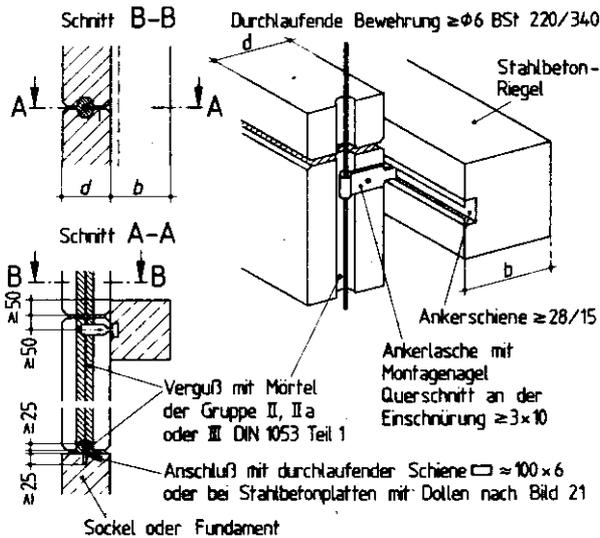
Anschluß von nichttragenden, stehend angeordneten Wandplatten an Stahlbeton-Riegeln (Maße in mm)
